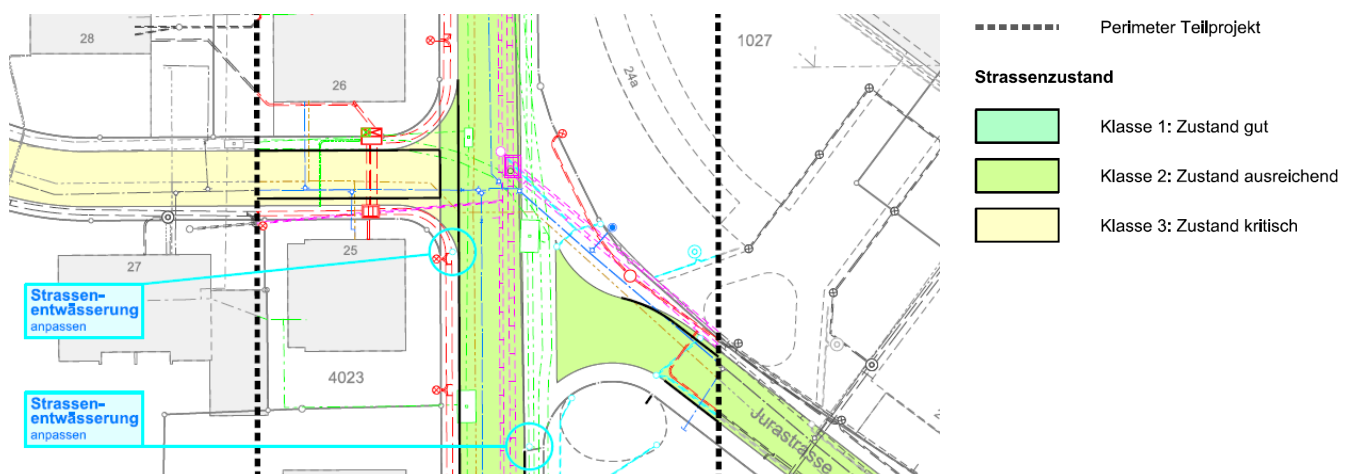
Ausschnitt Bestvariante Knoten Aarwangen-/ Jurastrasse (vgl. Massnahmenplan Werkleitungen, Anhang 2)
